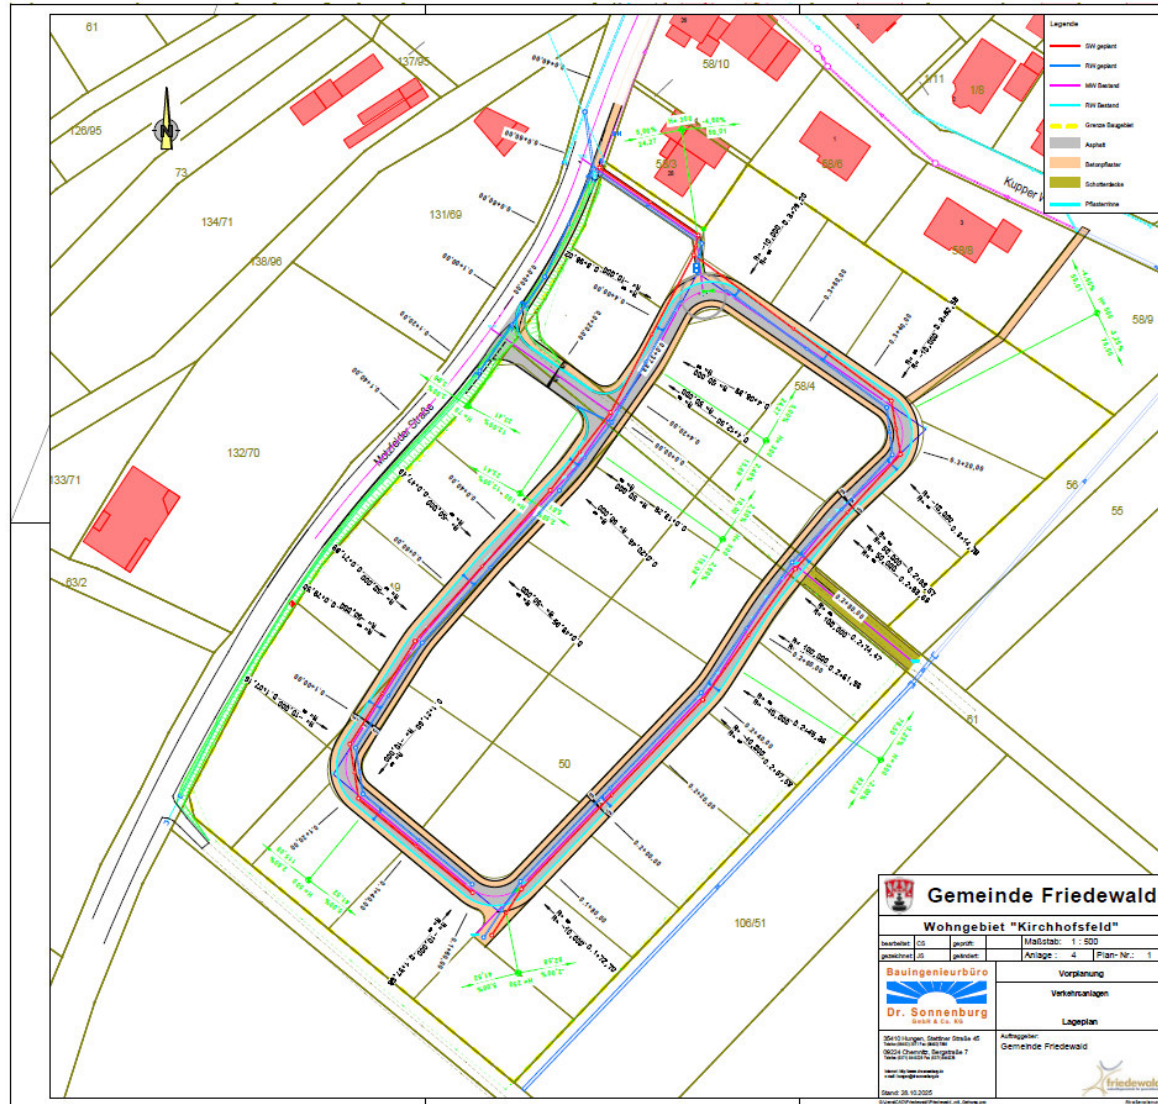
Erschließungsplan Verkehrsanlagen, Vorplanung (BAUINGENIEURBÜRO DR. SONNENBURG 2025).
